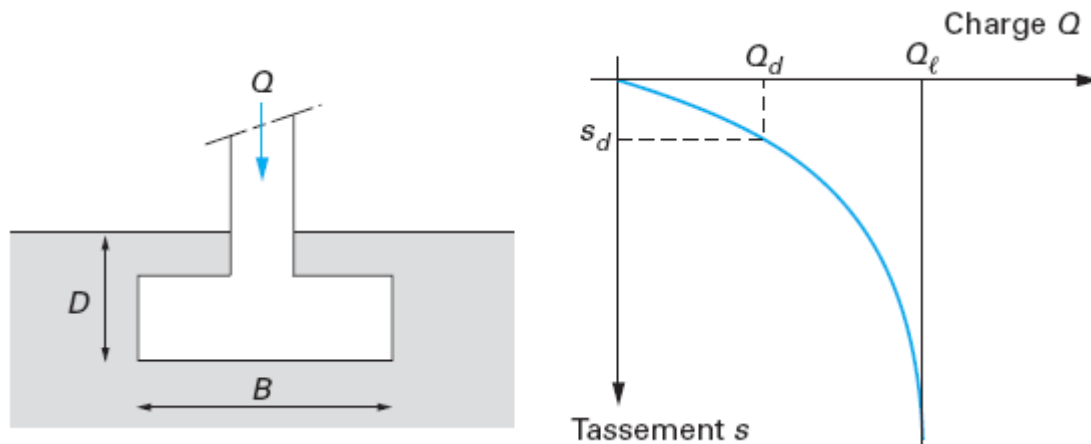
Courbe chargement-tassement d'une fondation superficielle.
